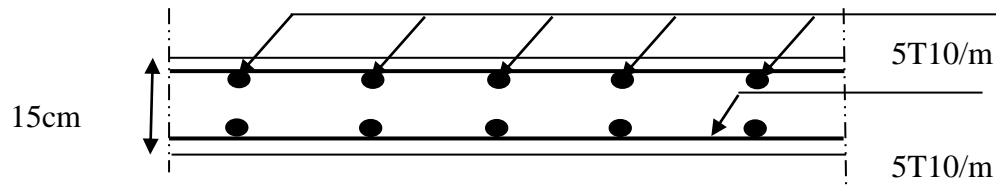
coupe horizontale du ferrailage du voile périphérique.
